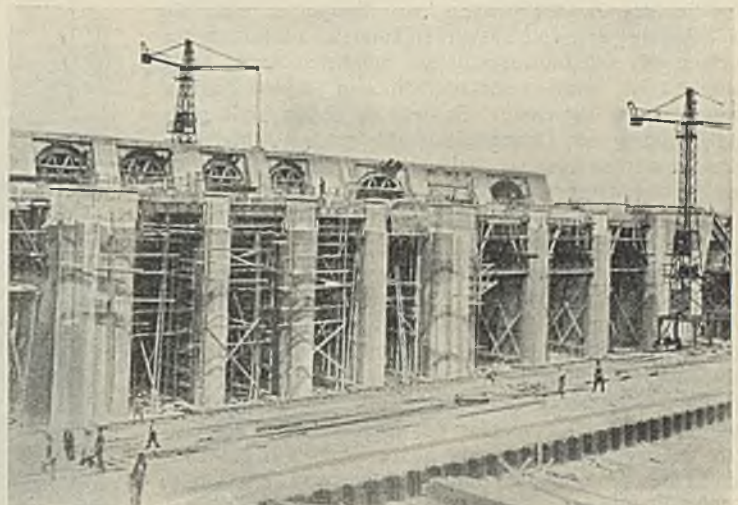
Staubecken Ottmachau. Grundablaß vom Unterwasser aus.
